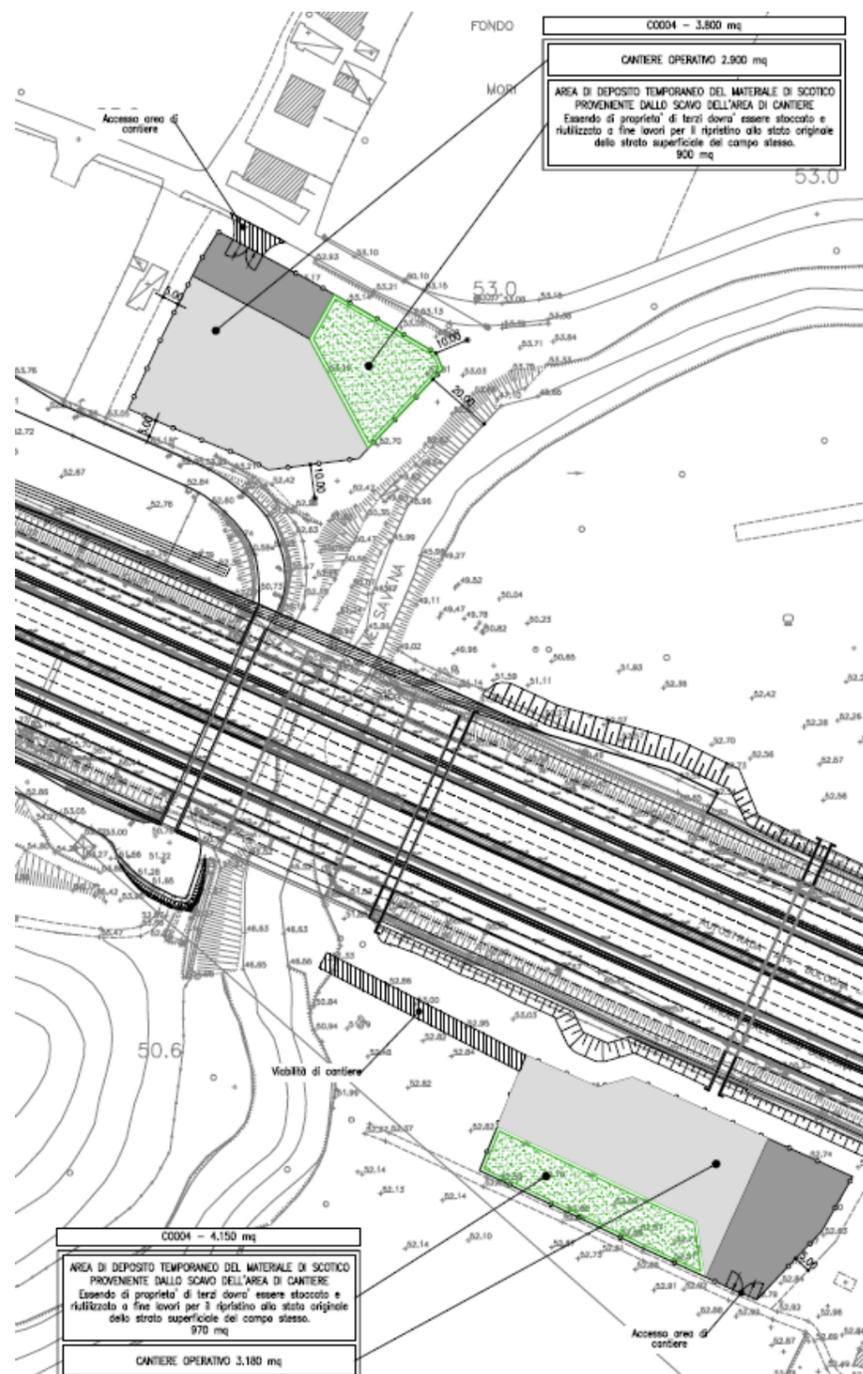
area di cantiere CO04 (estratto tav. CAP0330-0)
